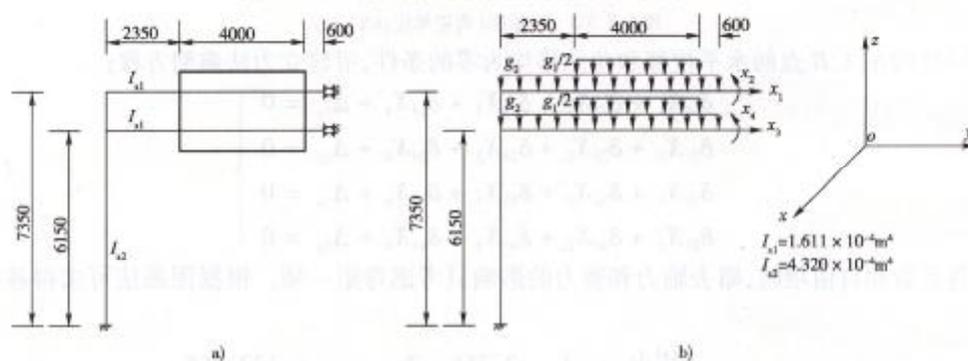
门架计算简图(尺寸单位:mm)
